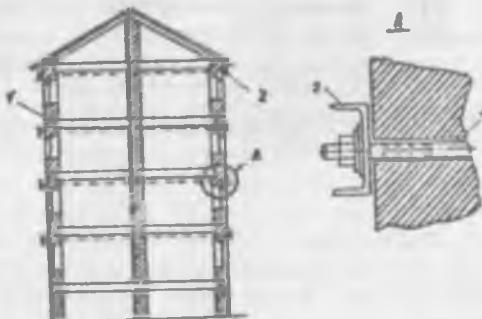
КРЕПЛЕНИЕ КАМЕННЫХ СТЕН НАКАЛАДКАМИ И ТЯЖАМИ
